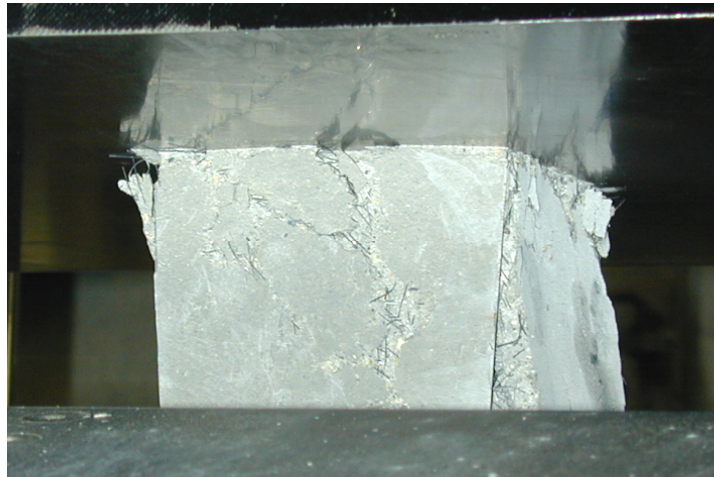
Würfel zwischen den Druckplatten der Prüfmaschine
